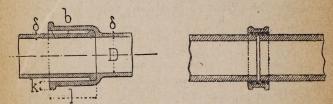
Assemblage à emboîte- Fig. 7. — Assemblage à bague.
